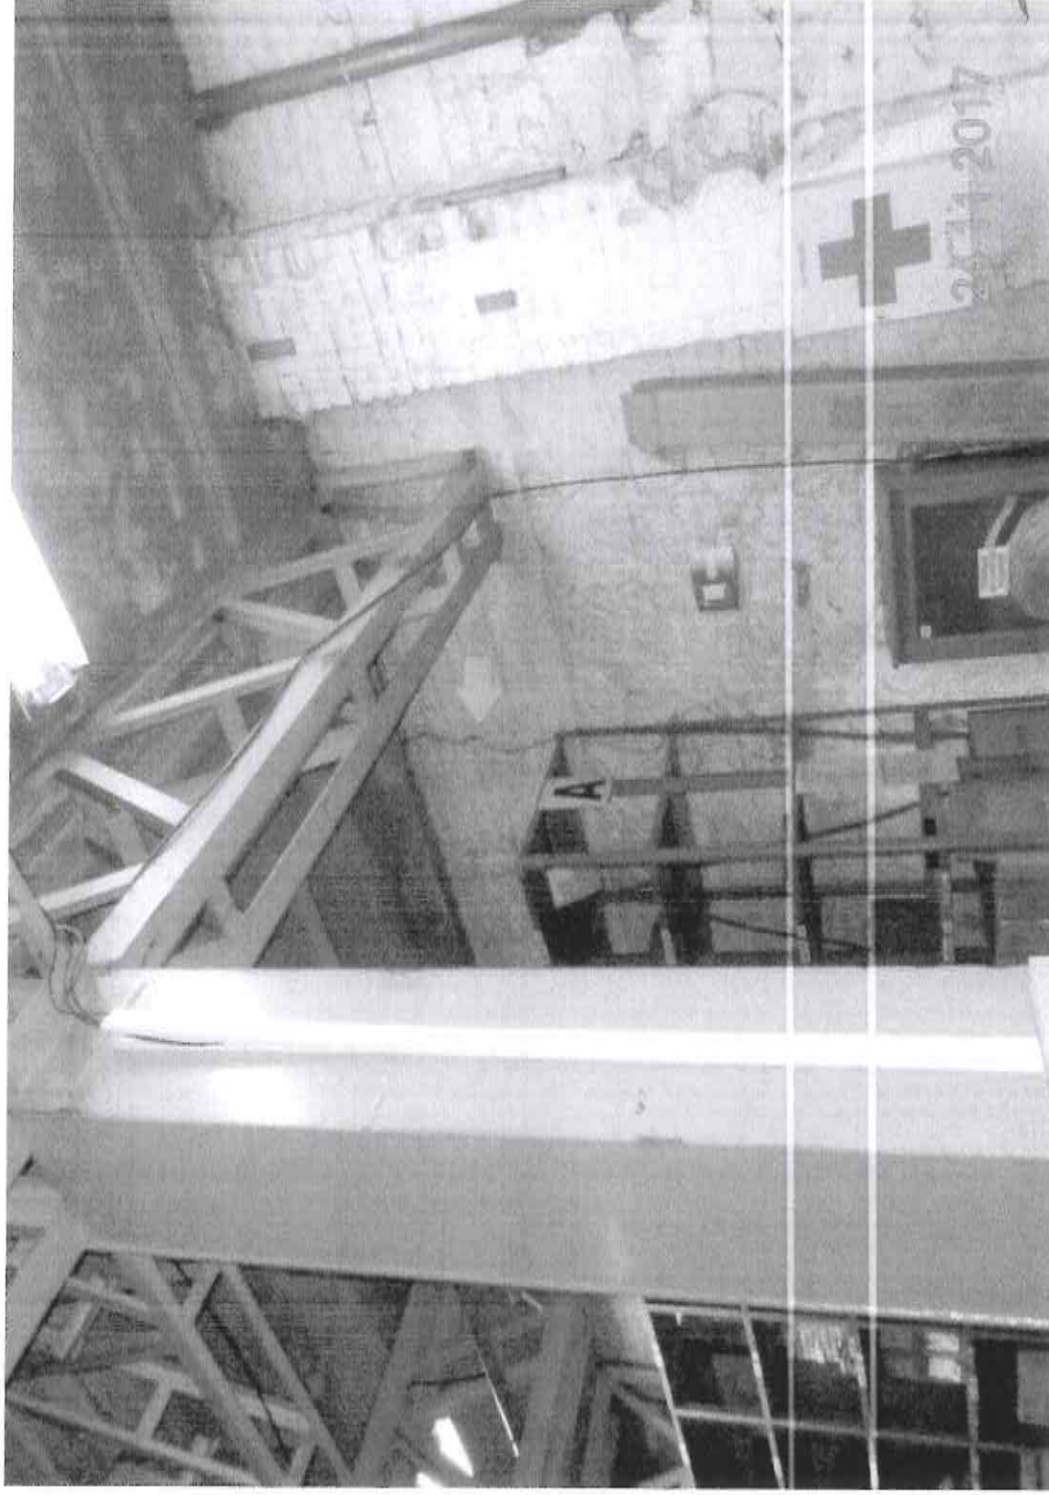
Vano realizado para inducir una puerta en el muro transversal intermedio de la BM-1, sin un confinamiento adecuado.
